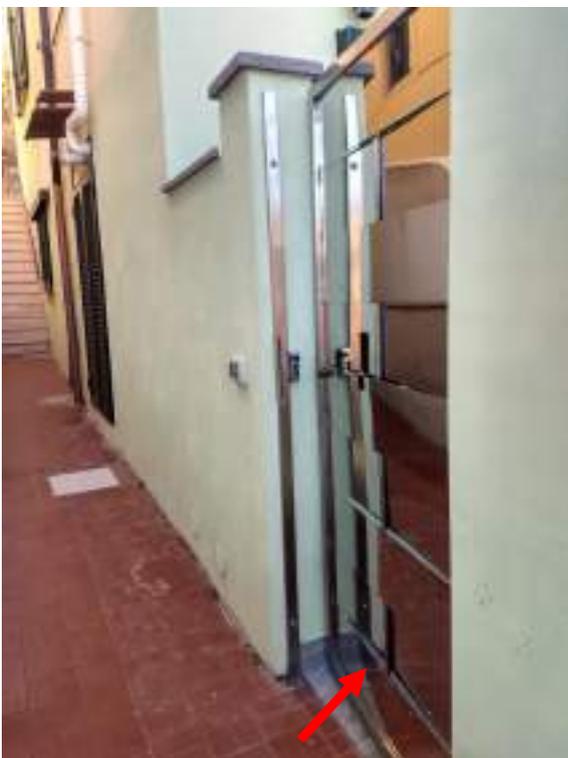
Vista dell' corridoio esterno comune con ingresso dalla Via Argentiera.
